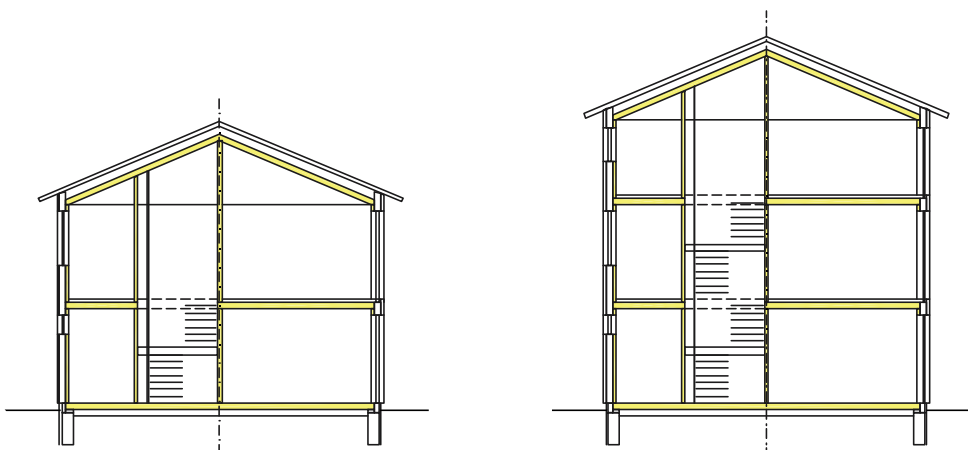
Schnitte Zeltdach, 2- und 3-geschossig, M 1:200
